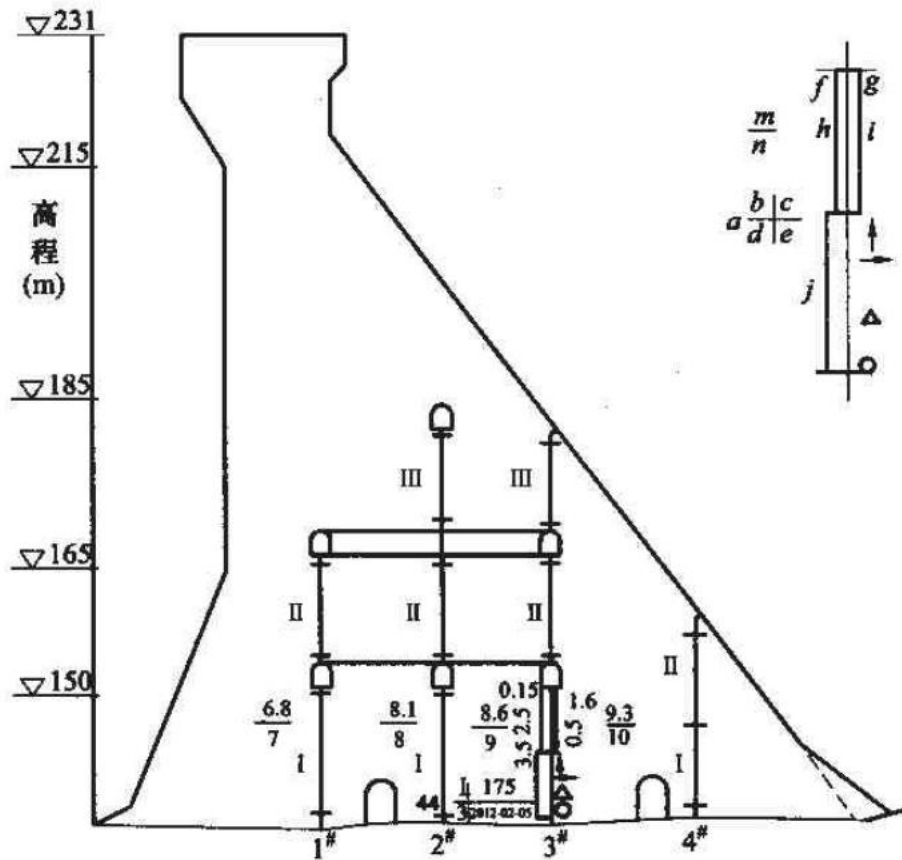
混凝土坝接缝（纵缝）灌浆综合剖面图
